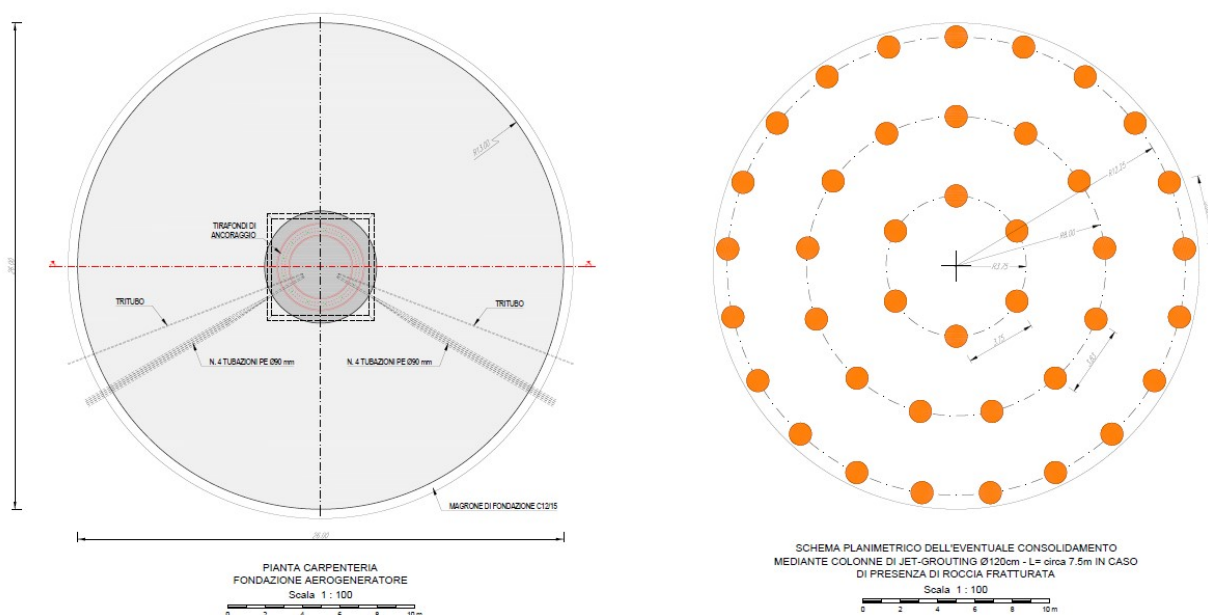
Schema tipo della fondazione dell'aerogeneratore ed eventuale consolidamento del terreno con colonne di jet-grouting.
